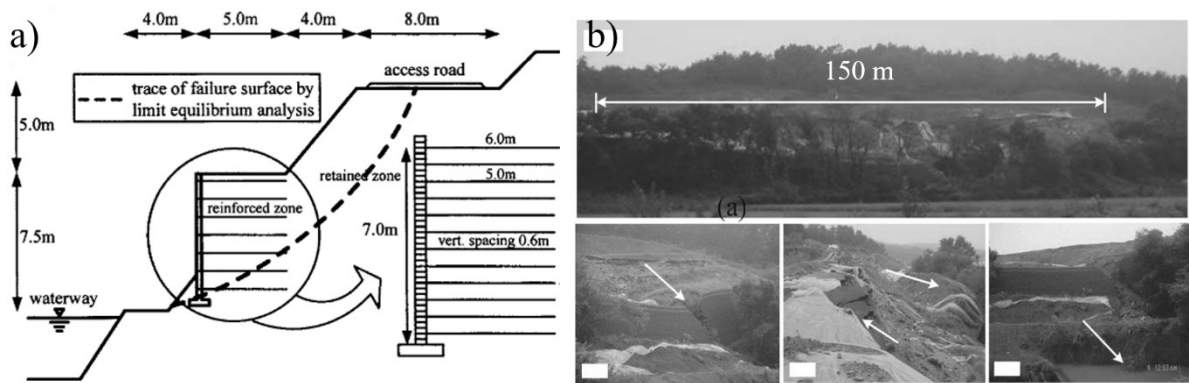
Ruptura de uma ESRG em Chung-Nam, Coreia do Sul: a) Geometria estrutural; b) Após colapso (YOO e JUNG, 2006).
